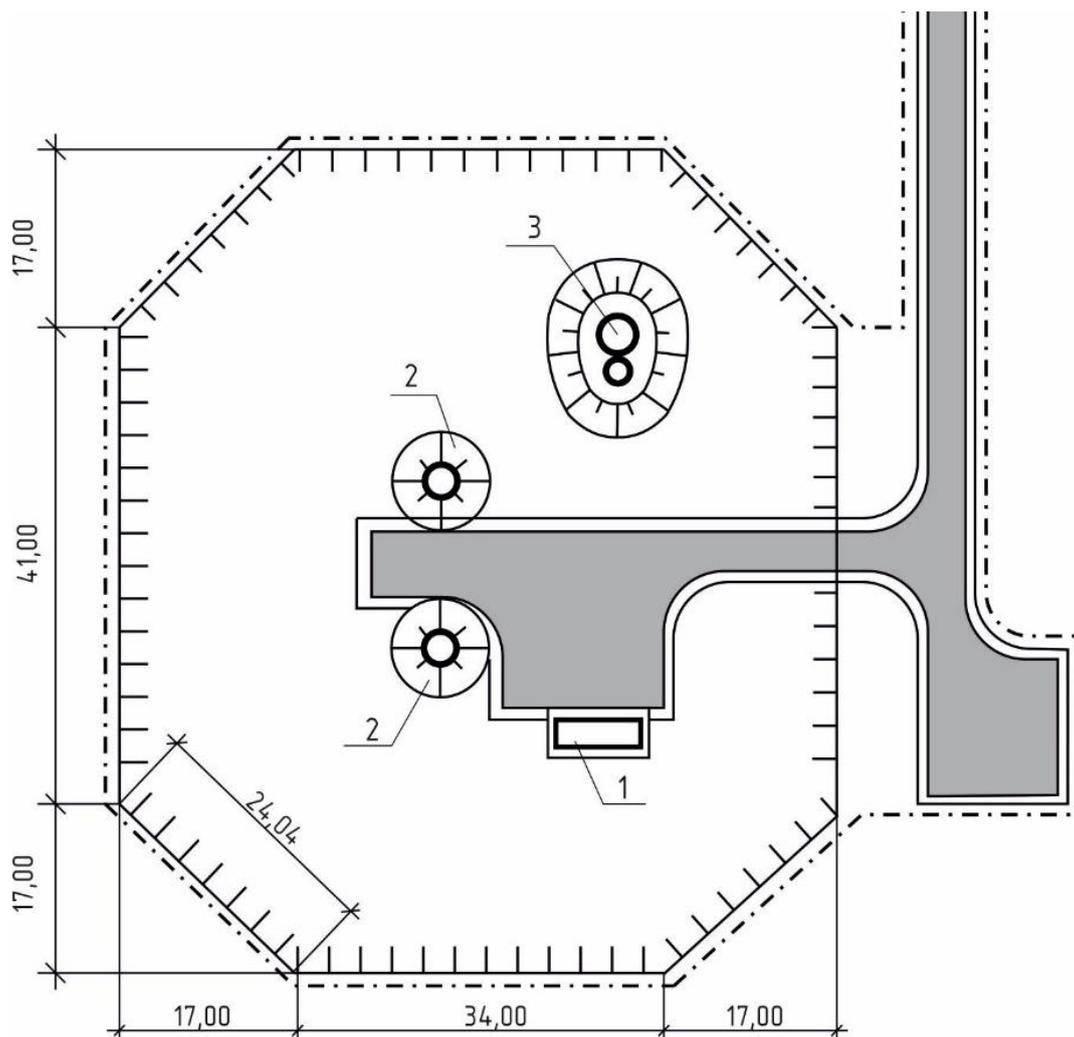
Схема генплана зоны водозаборных сооружений:
